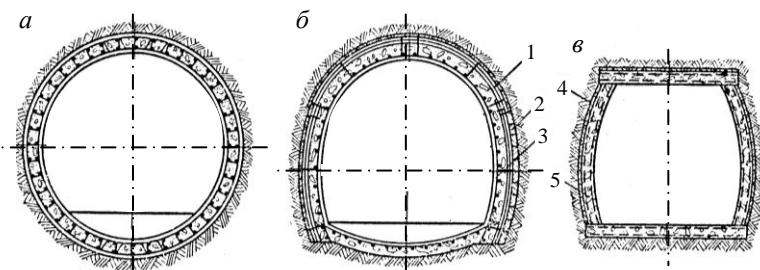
Монолитная железобетонная крепь: а – кольцевая с гибкой арматурой, б – подковообразной формы со смешанной арматурой, в – бочкообразная с жесткой арматурой, 1 – арка из спецпрофиля, 2 – железобетонные затяжки, 3 – гибкая арматура, 4 – двутавровые элементы рамы, 5 – железобетонные затяжки
